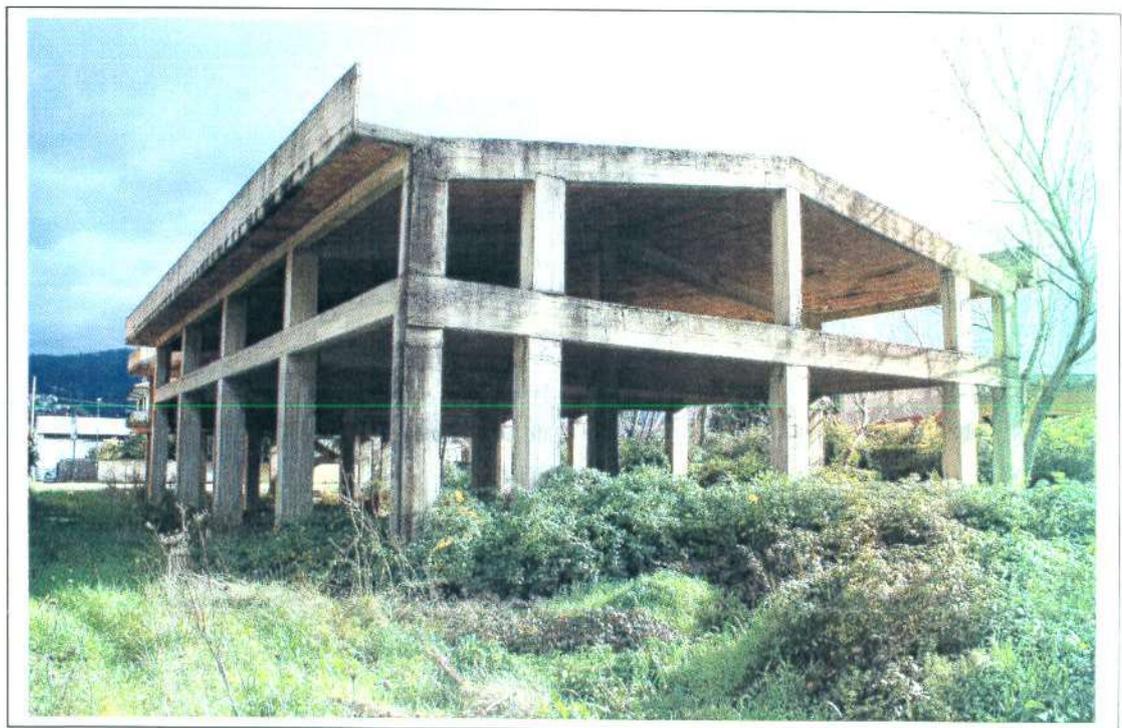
Veduta da OVEST (*fronte Ferrovia*)
